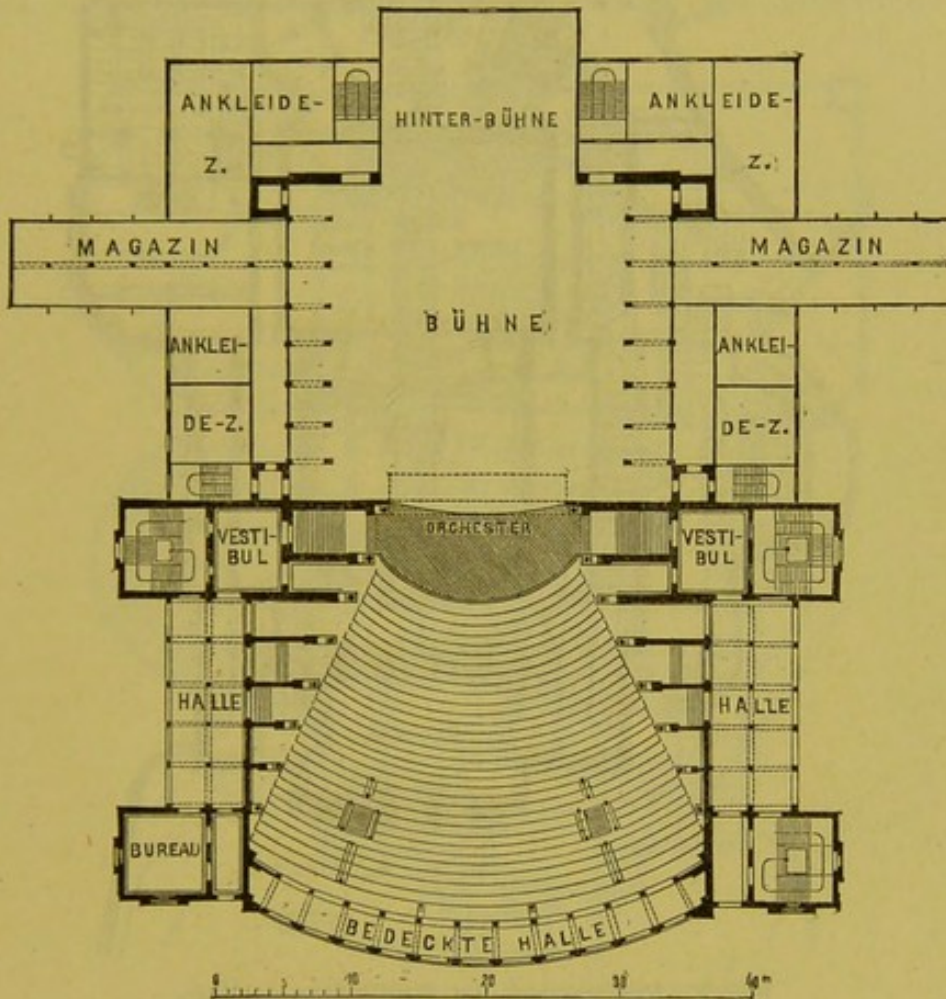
Grundriß des Bühnenfestspielhauses in Bayreuth.
